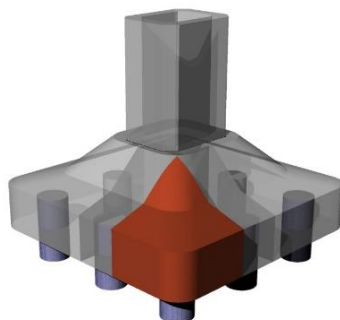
Détail de la jambe du pylône, de la semelle et du système de pieux.
